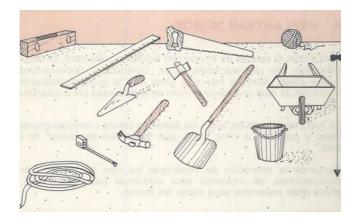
Herramientas para mampostería Fuentes: Autoconstrucción, Muros - SENA
